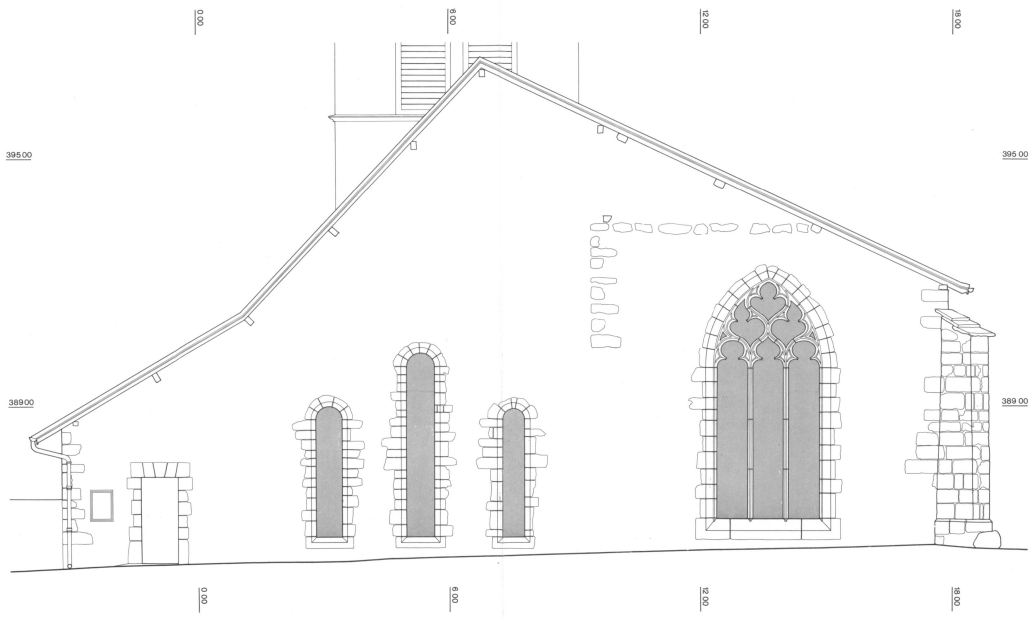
Elévation extérieure du mur est. Echelle 1 : 100.
